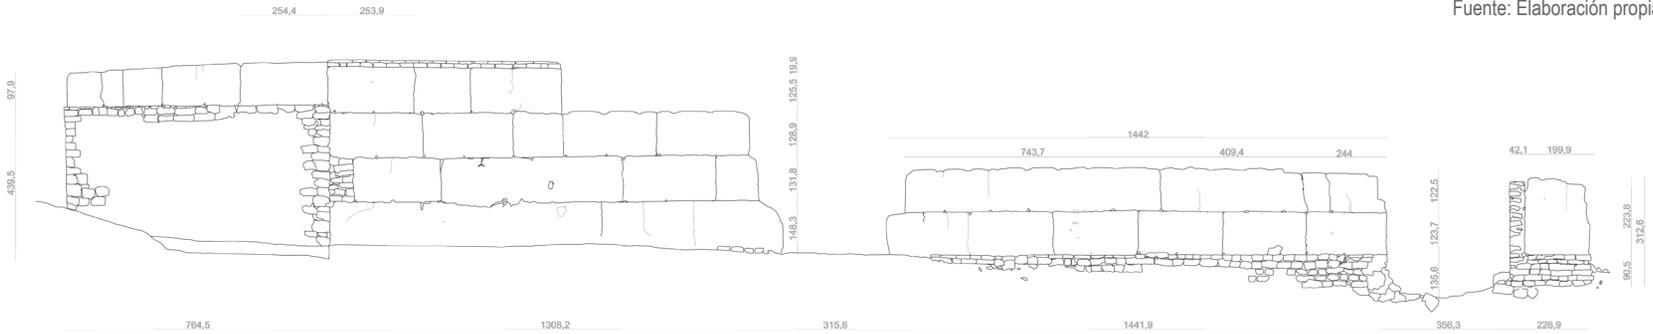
Levantamiento fachada principal de Mina Constanca.
